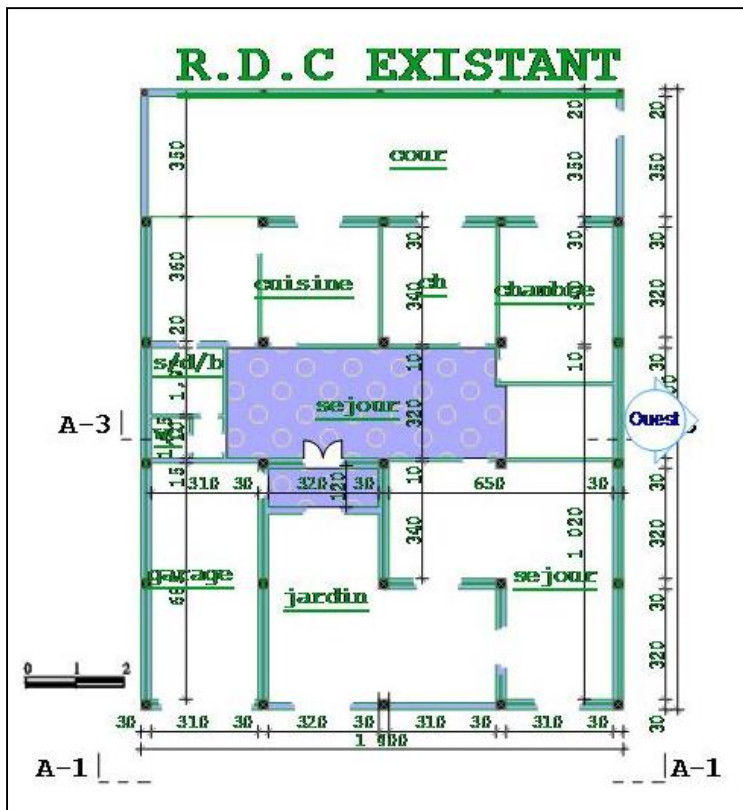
,échantillon 01, représentation graphique d'un plan RDC, conçu et réalisé ,(Plan type) lotissement EL AMAL
